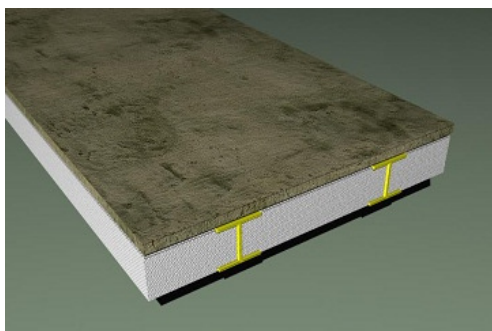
Laje mista de concreto/ PRFV (SANTOS NETO, 2006).
